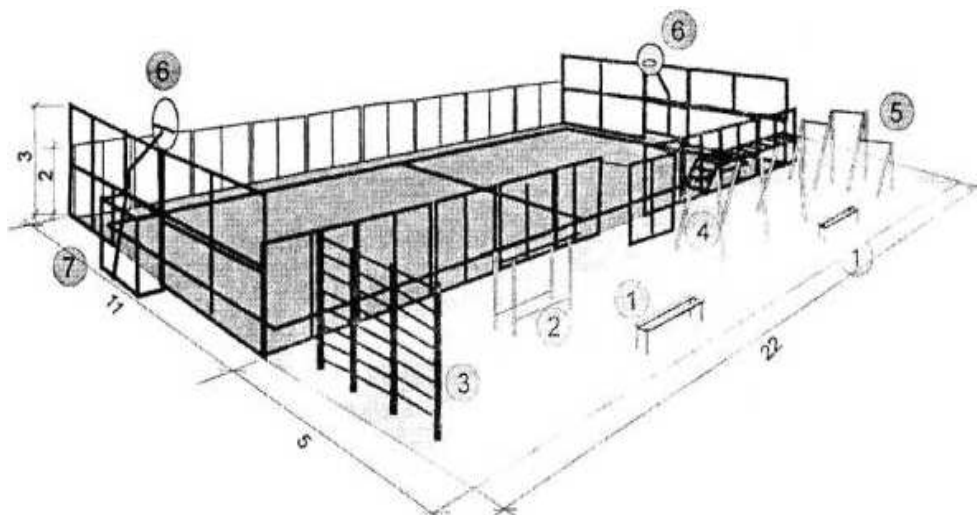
Оборудование комплексной площадки для подвижных игр [СП 31.115-2006]: 1 – скамья; 2 – брусья; 3 – шведская стенка; 4 – рукоход; 5 – перекладины разновысокие; 6 – стойка баскетбольная; 7 – ворота для мини-футбола
